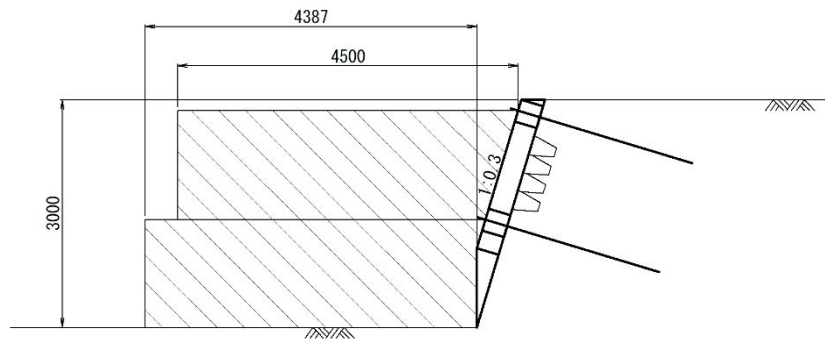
重力式コンクリート擁壁工法、鉄筋コンクリート擁壁工法の施工スペースの目安
